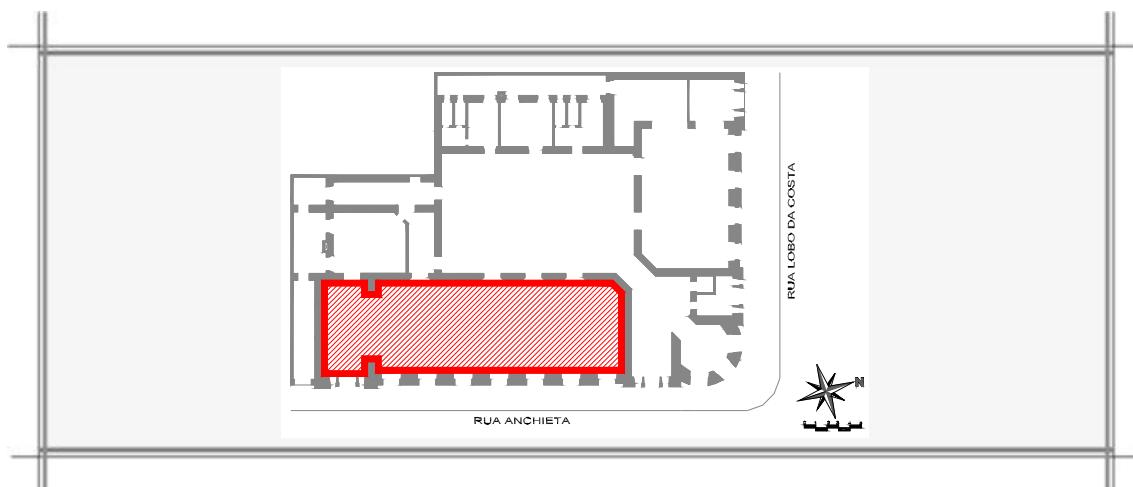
Planta Baixa do 1º Pav, com a localização do Restaurante. Desenho: Cristiane Müller.
